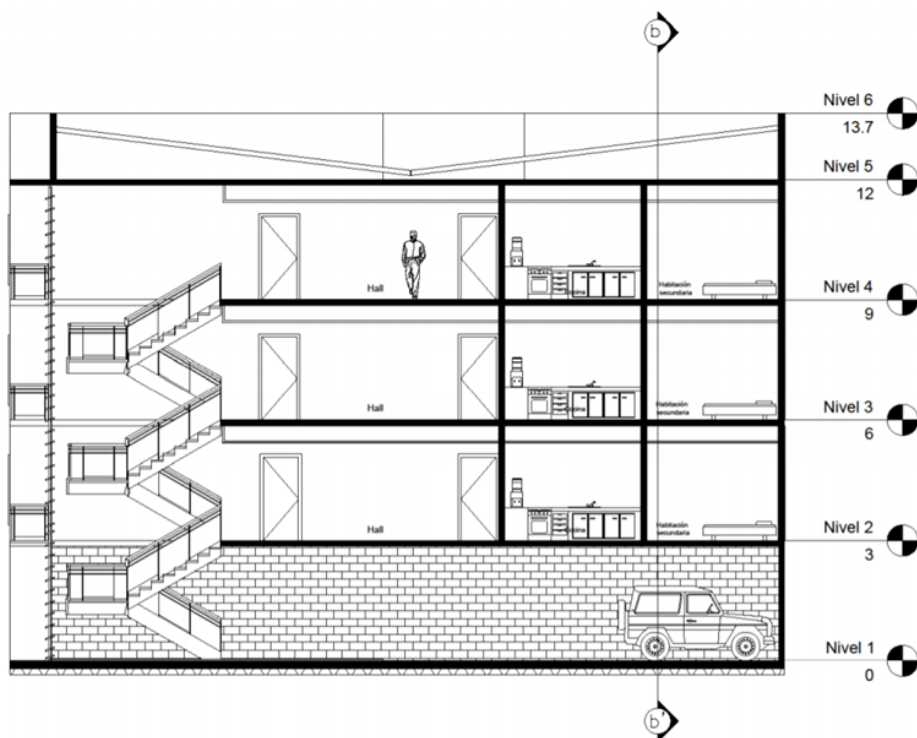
Corte transversal de la edificación, constructora Proyectos y Soluciones de Ingeniería P.S.I. Ltda. Fuente: Creación propia.
